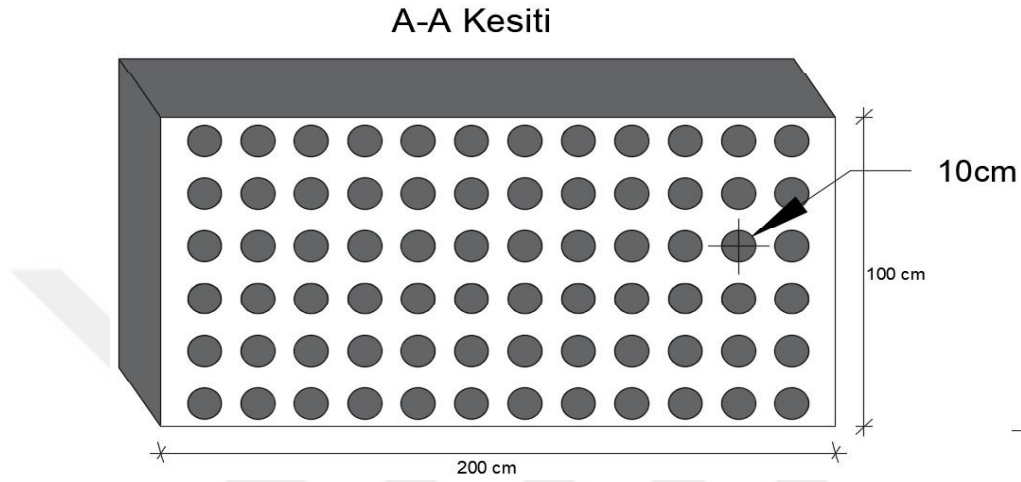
Döküm yönüne dik donatılı karotların alınması için üretilen betonarme blok
